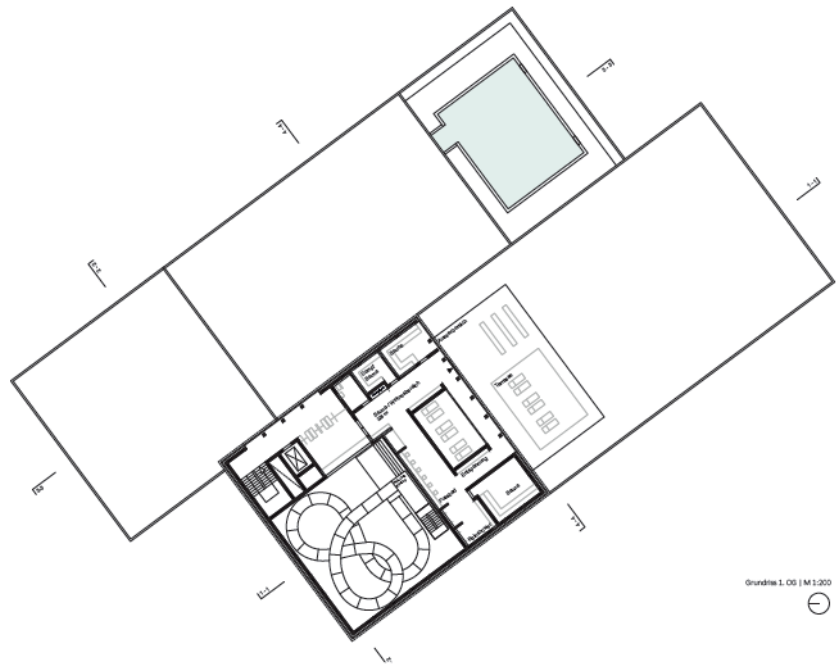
Grundriss Obergeschoss (ohne Massstab)
